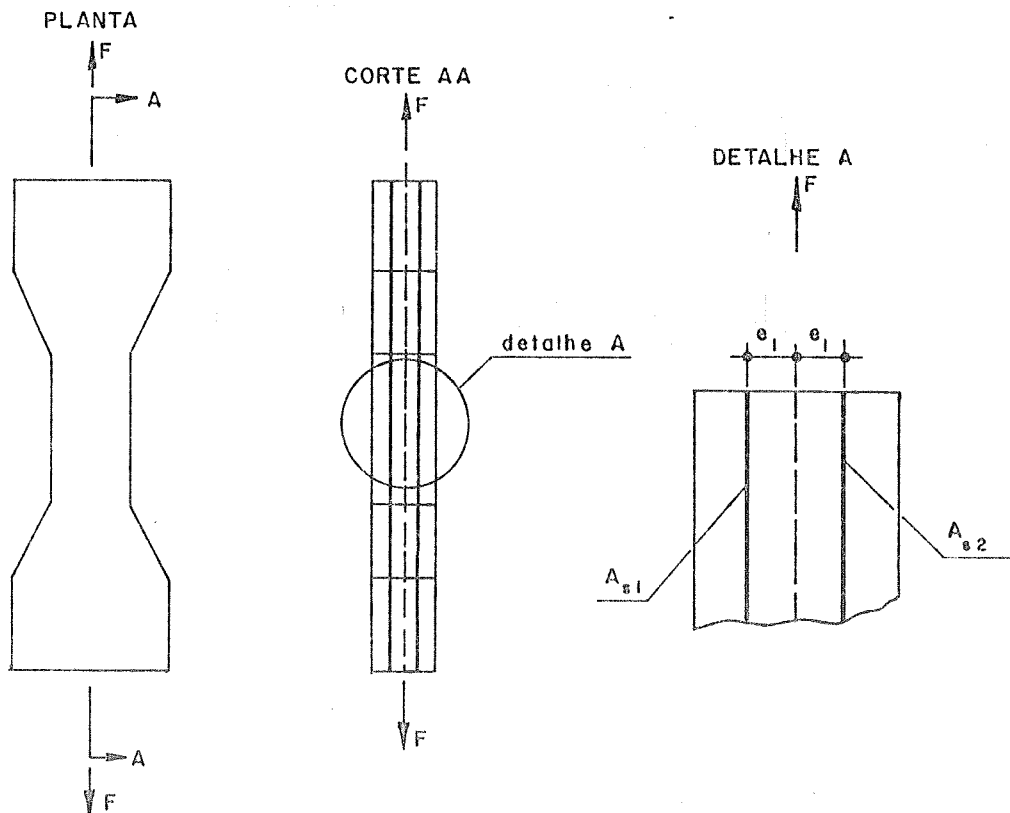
Situação de carregamento de chapa com armaduras distintas, dispostas simetricamente.
